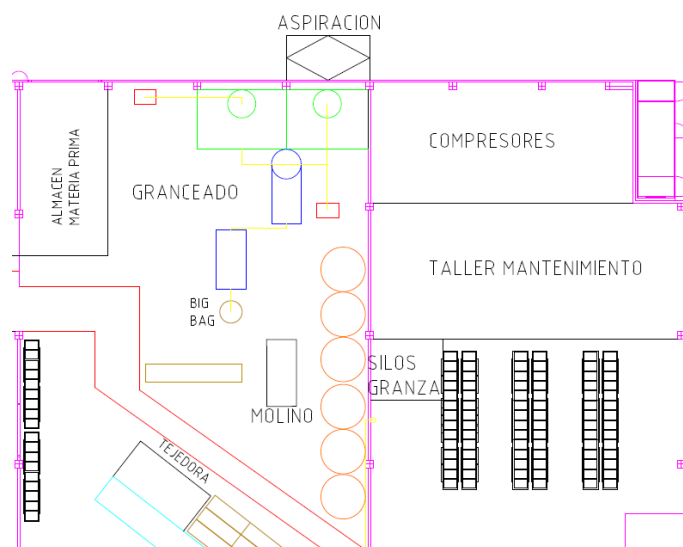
Plano ampliado planta productiva Persianas Persax, zona granceado PVC
